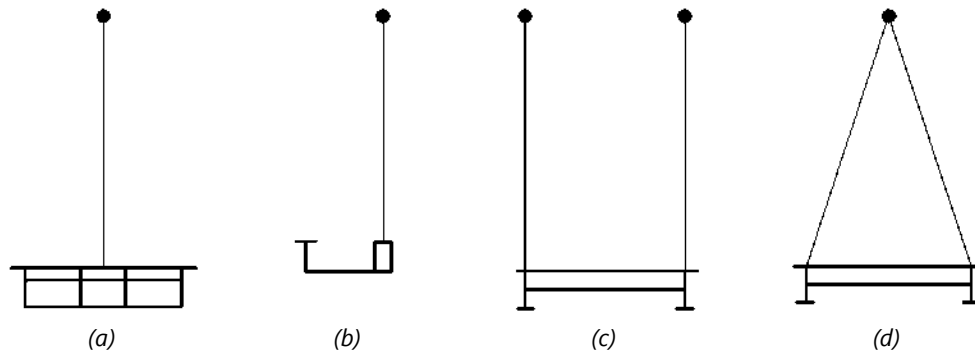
e Arreglo transversal de los tirantes. a) vertical en un plano, b) vertical/lateral en un plano, c) vertical en dos planos, d) inclinado en dos planos.
